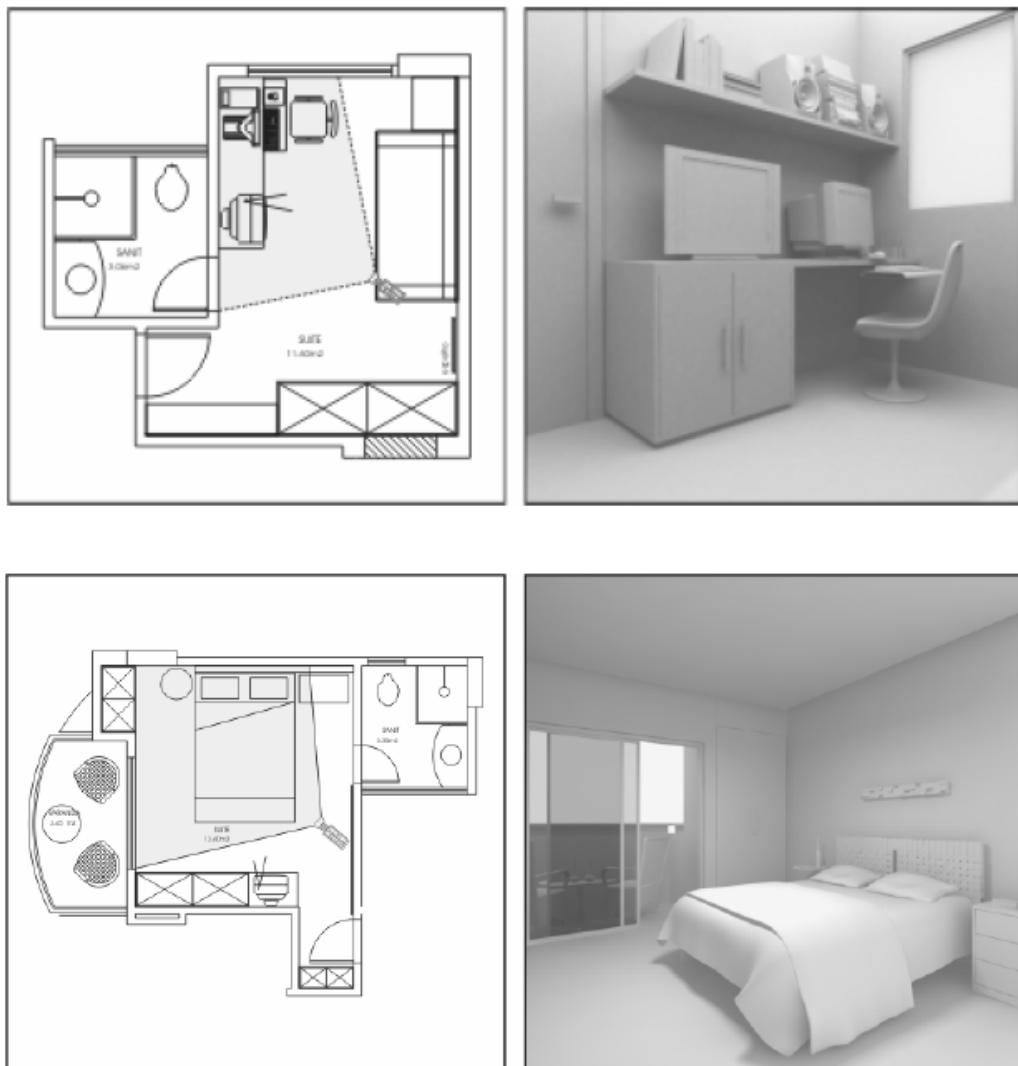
Planta baixa mostrando área de atuação da câmera e sua vista em 3D
